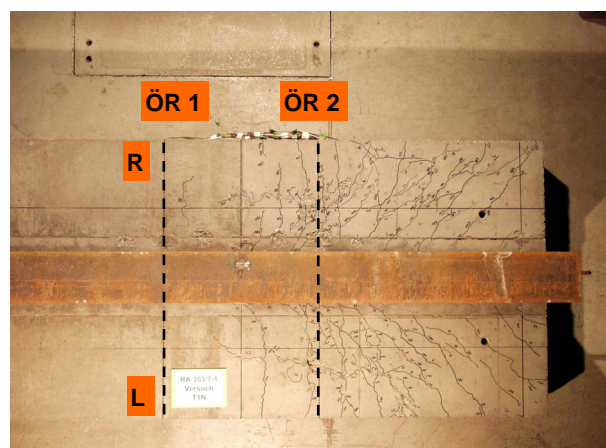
Rissbild auf der Betongurtunterseite
